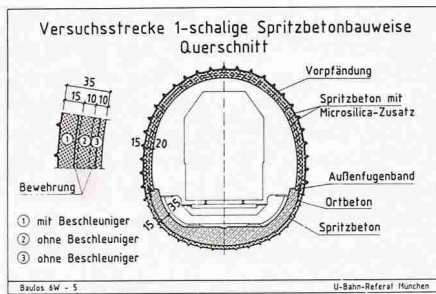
Einschaliger Tunnelausbau in Spritzbetonbauweise (NOT) einer Versuchsstrecke der Münchner U-Bahn - Querschnitt (Weber)
